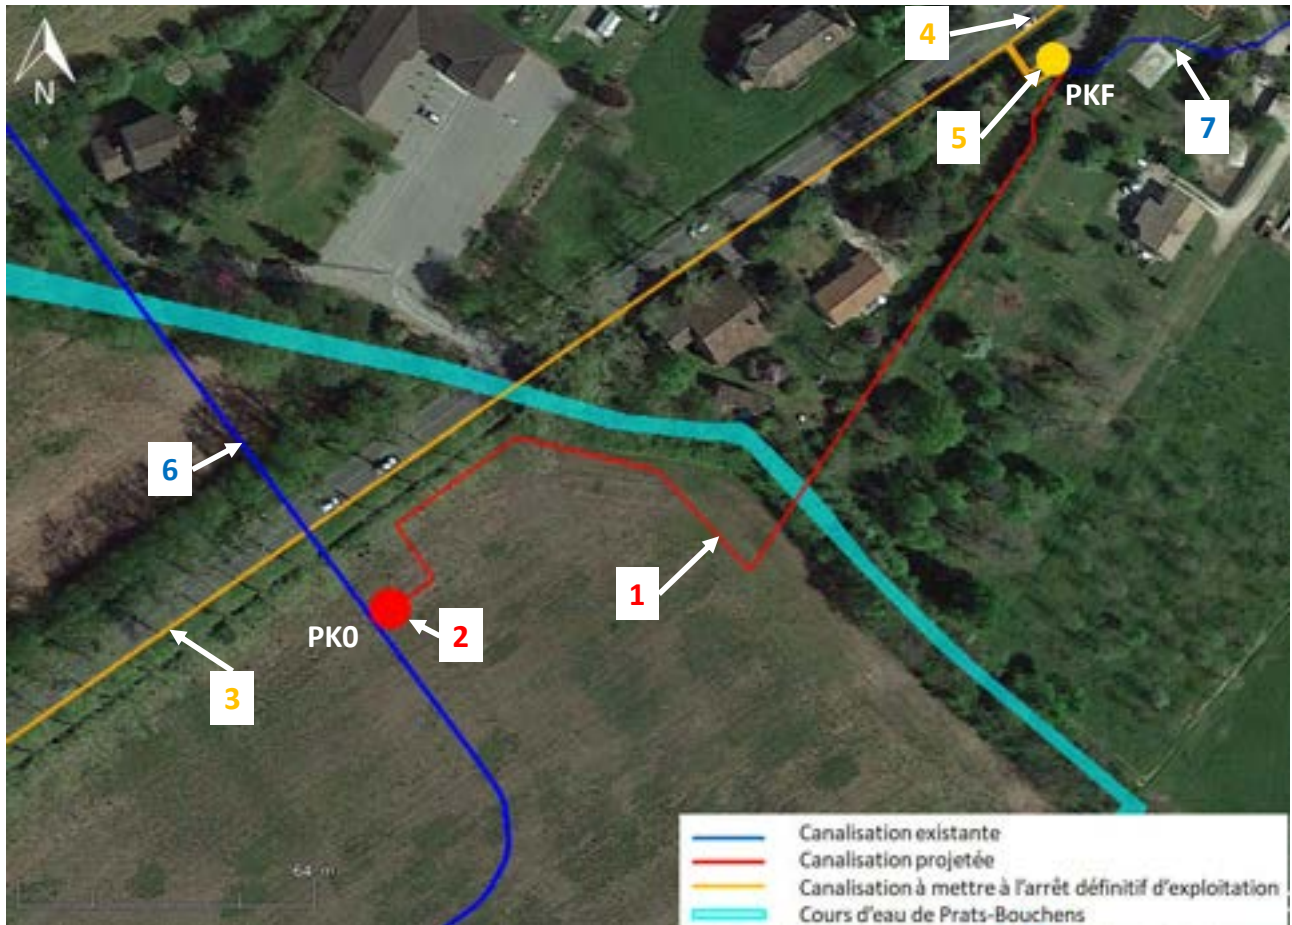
Raccordement au branchement DN80 SINERG EMISSION A MONTECH existant sous dalle et en sur-profondeur
